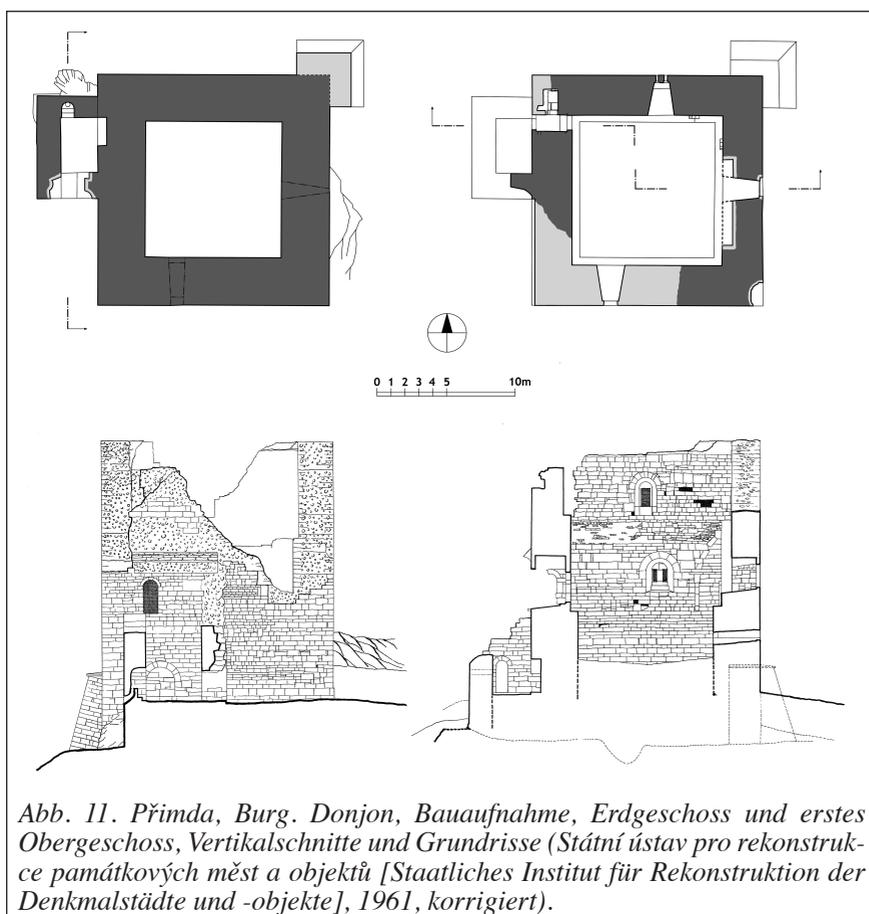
Přimda, Burg. Donjon, Bauaufnahme, Erdgeschoss und erstes Obergeschoss, Vertikalschnitte und Grundrisse (Státní ústav pro rekonstrukce památkových měst a objektů [Staatliches Institut für Rekonstruktion der Denkmalstädte und -objekte], 1961, korrigiert).
